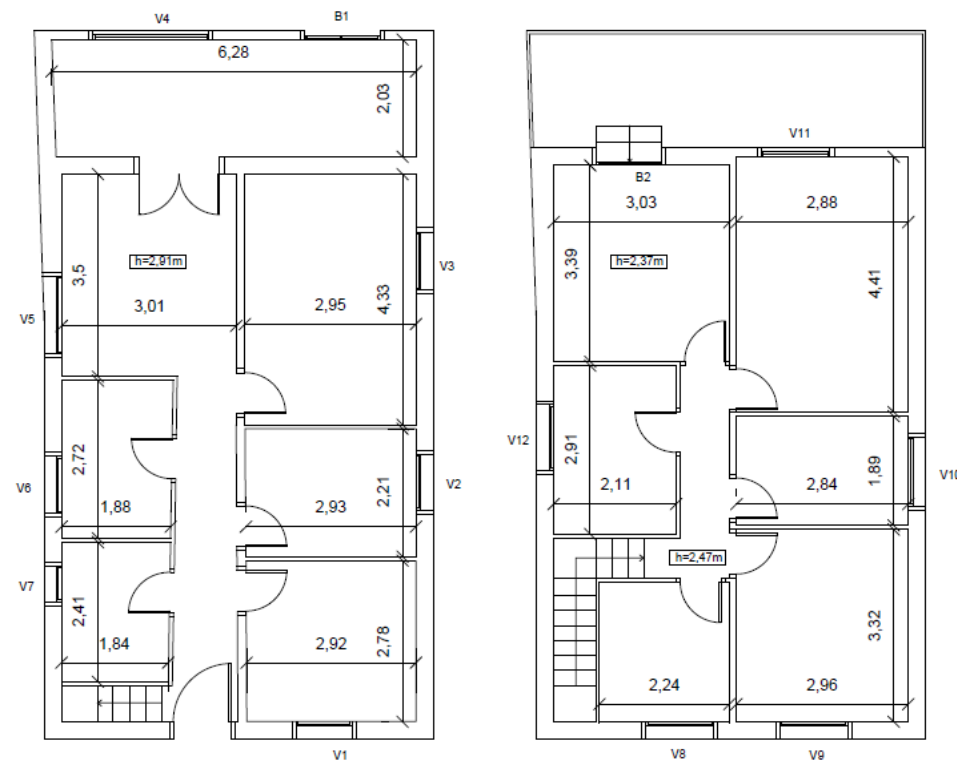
Plano de planta baja y planta primera de c/ Cànoves 1 de Barcelona
